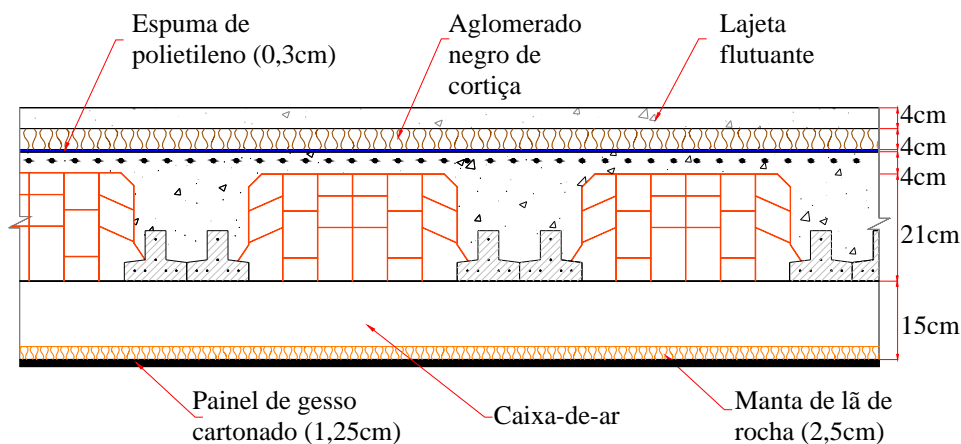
Pavimento aligeirado de vigotas pré-esforçadas e blocos cerâmicos de cofragem com tecto falso, isolante e lajeta flutuante (Pav3)
